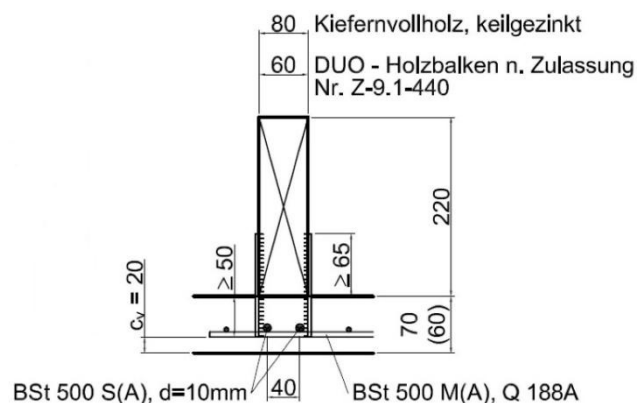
Dennert Holz-Beton Verbundelemente [abZ. Nr. Z-9.1-474]
